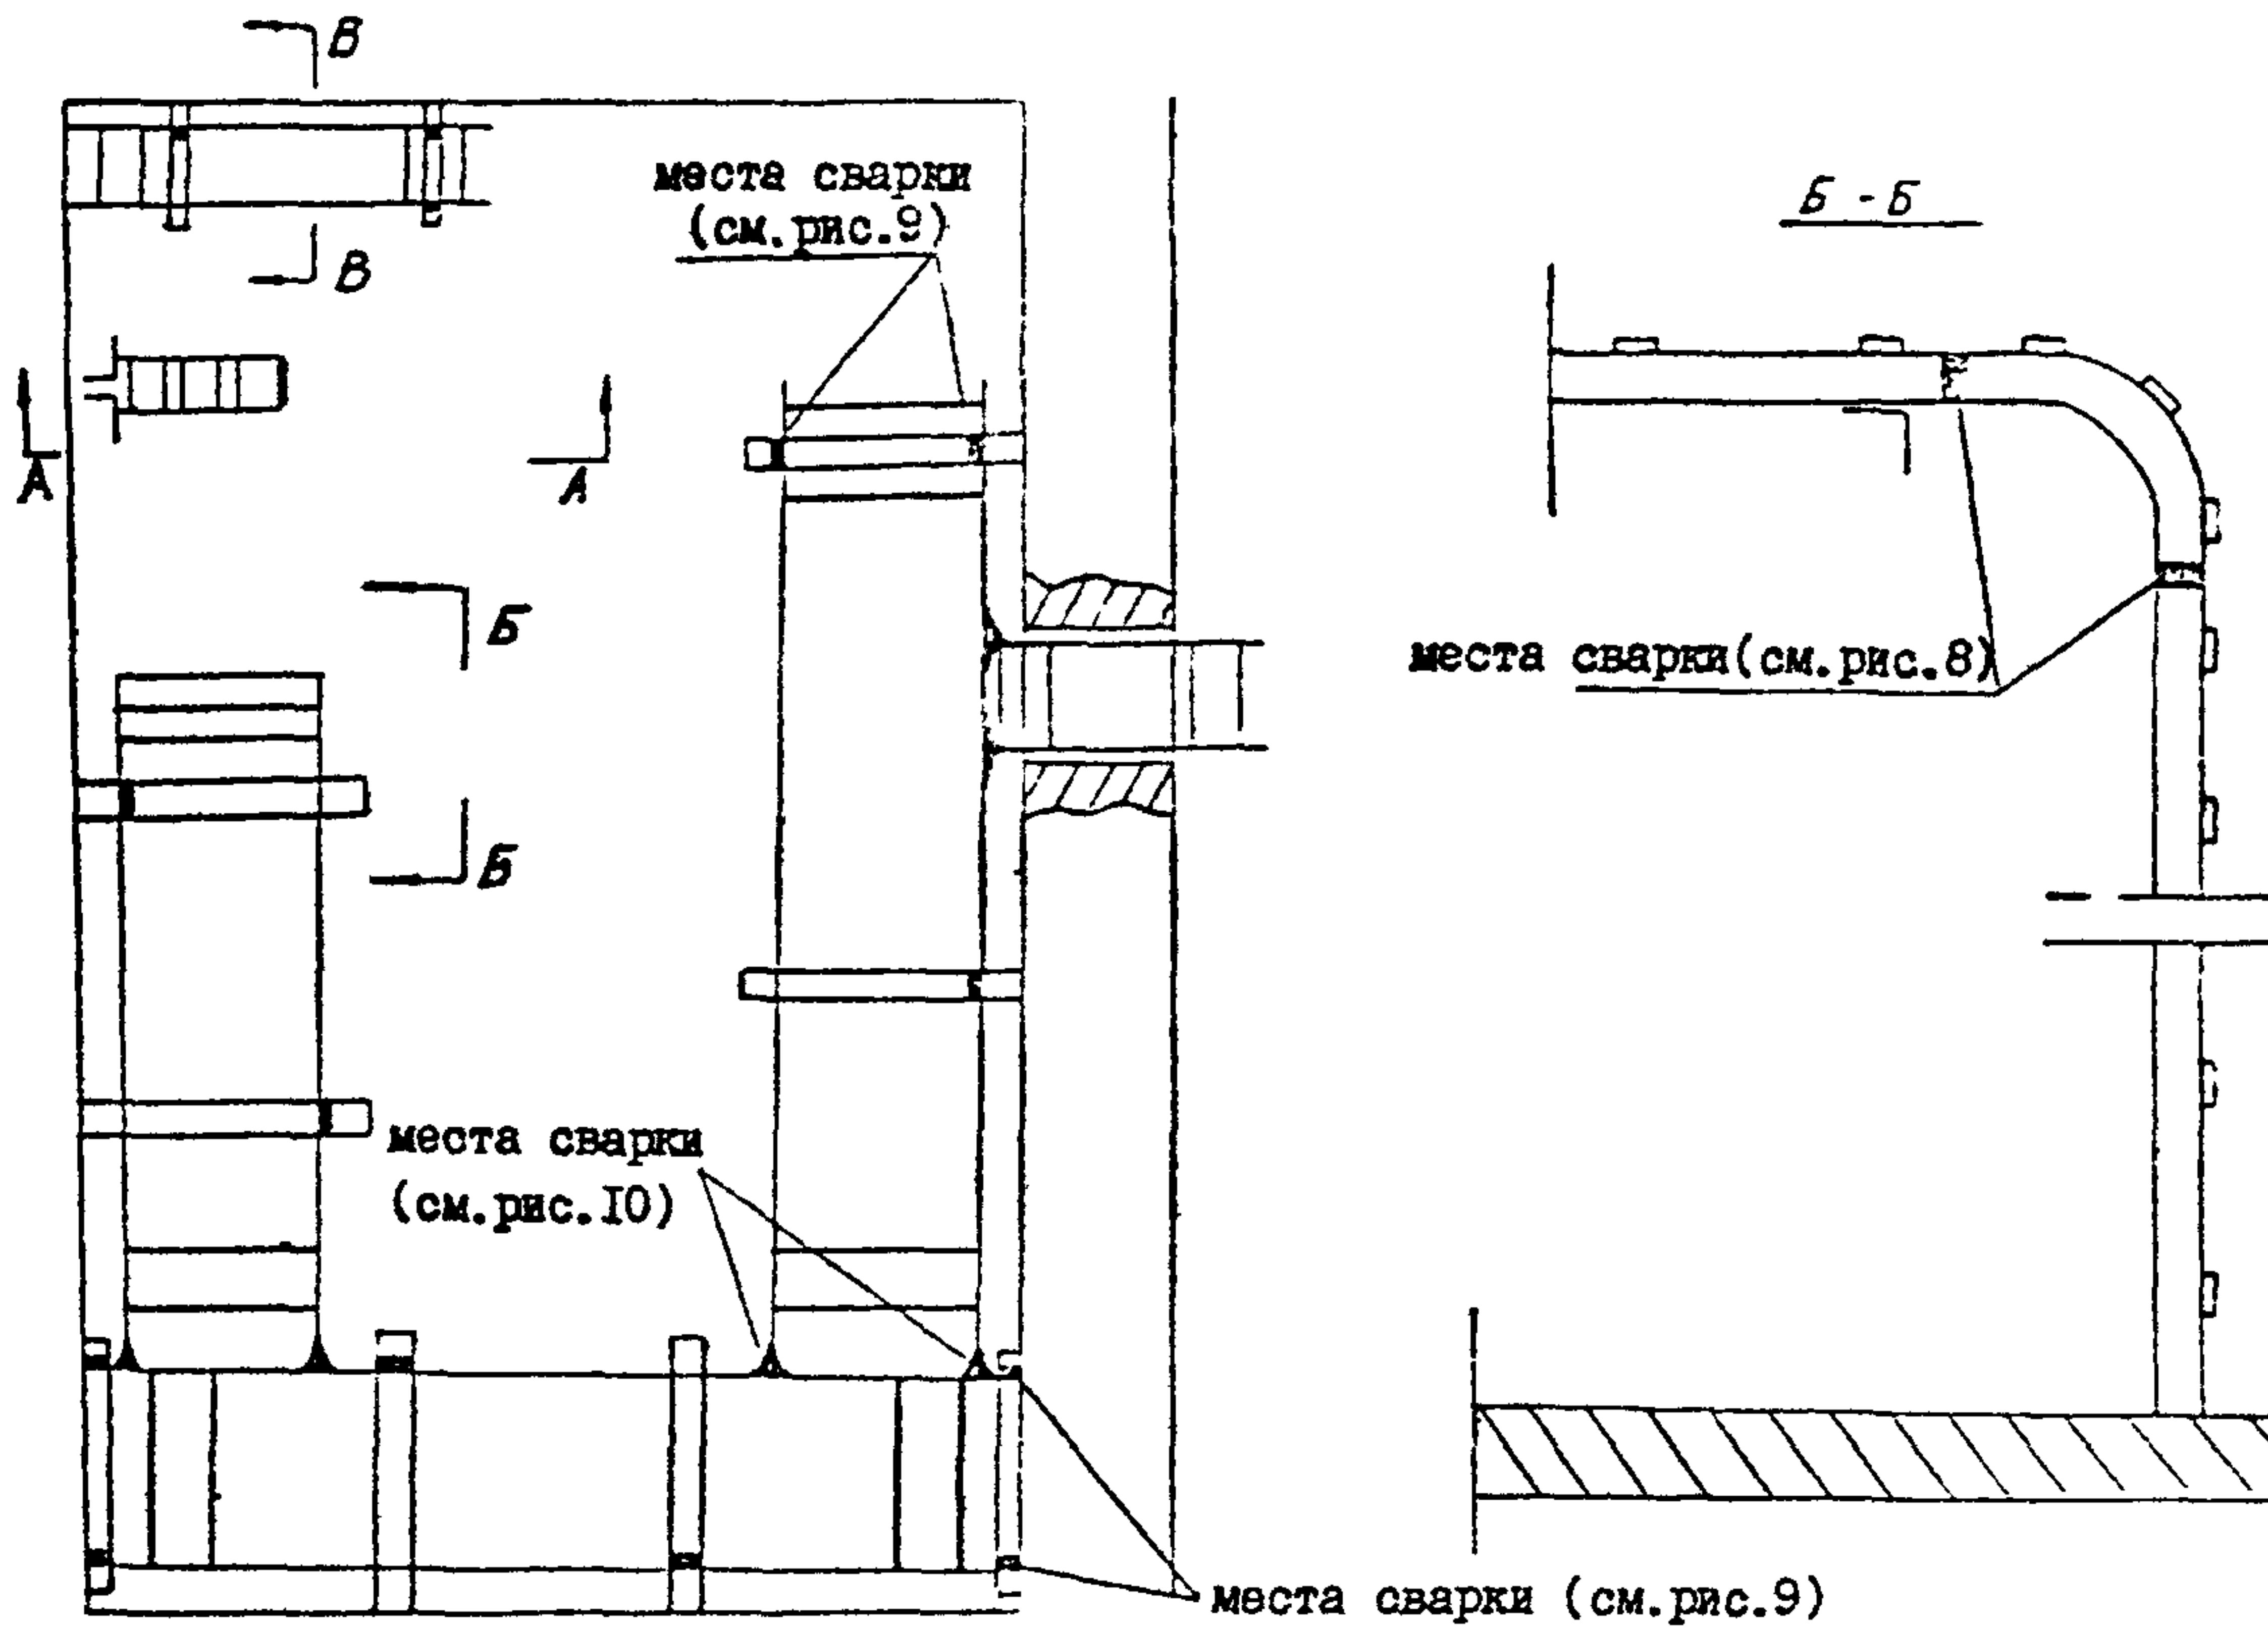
Расположение и места сварки желобов в шахте (примерное)
